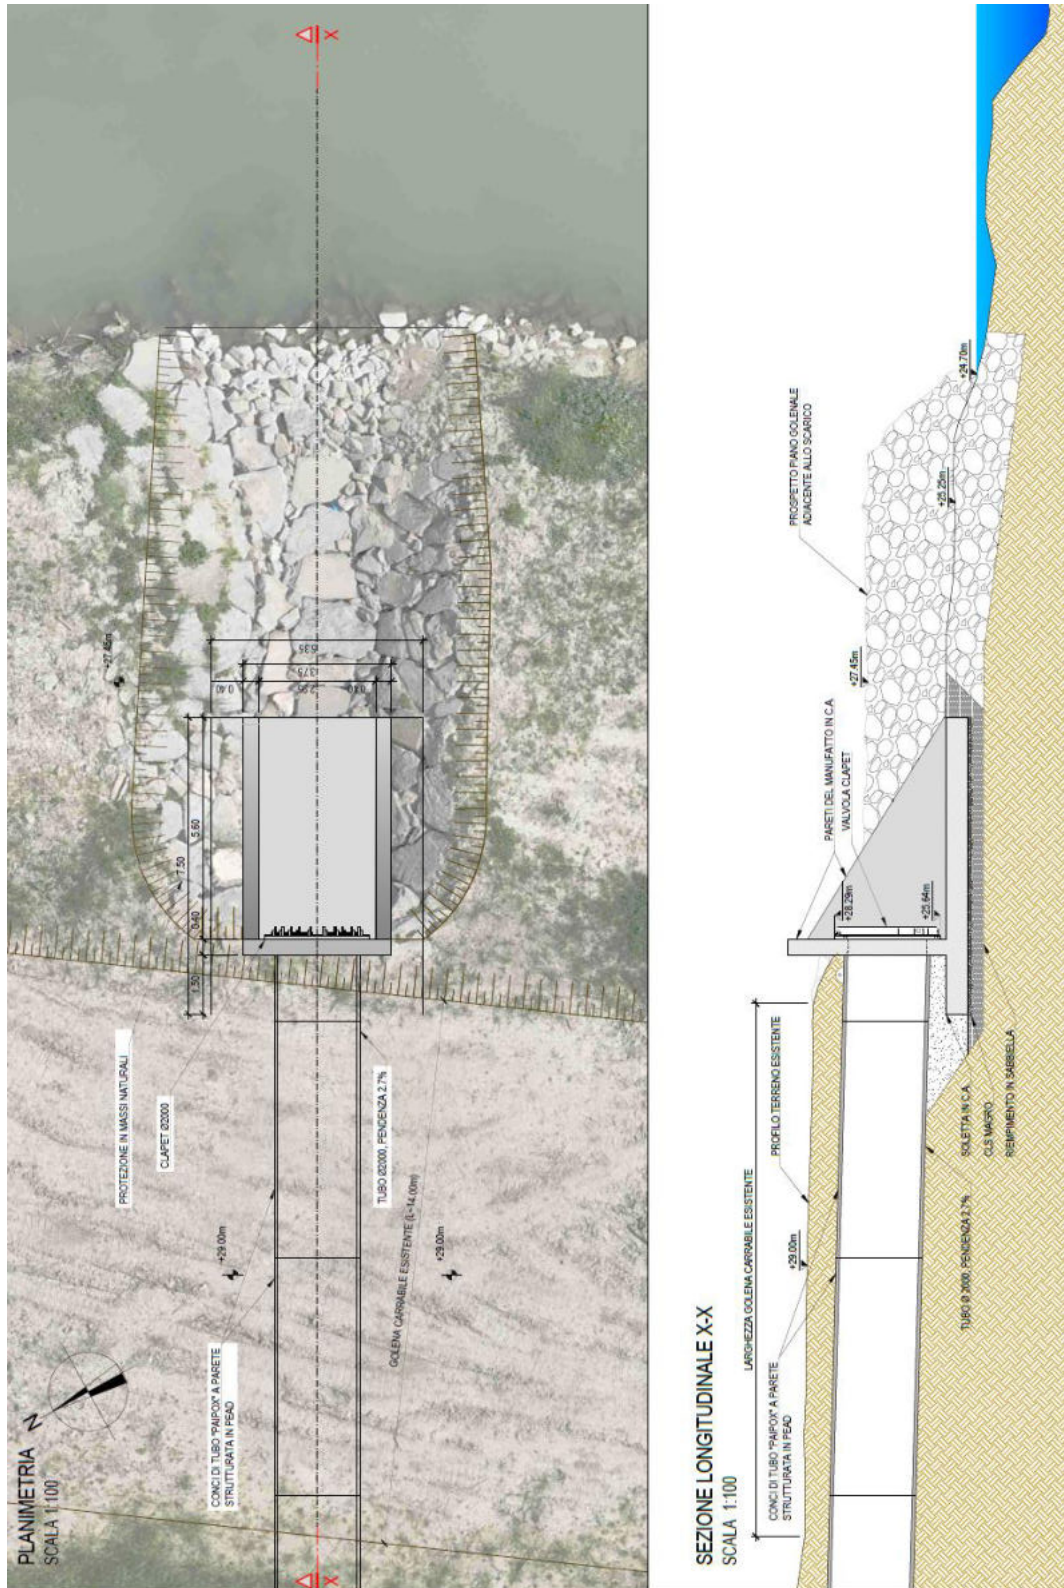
Pianta e sezione delle opere di protezione dello scarico n.33
